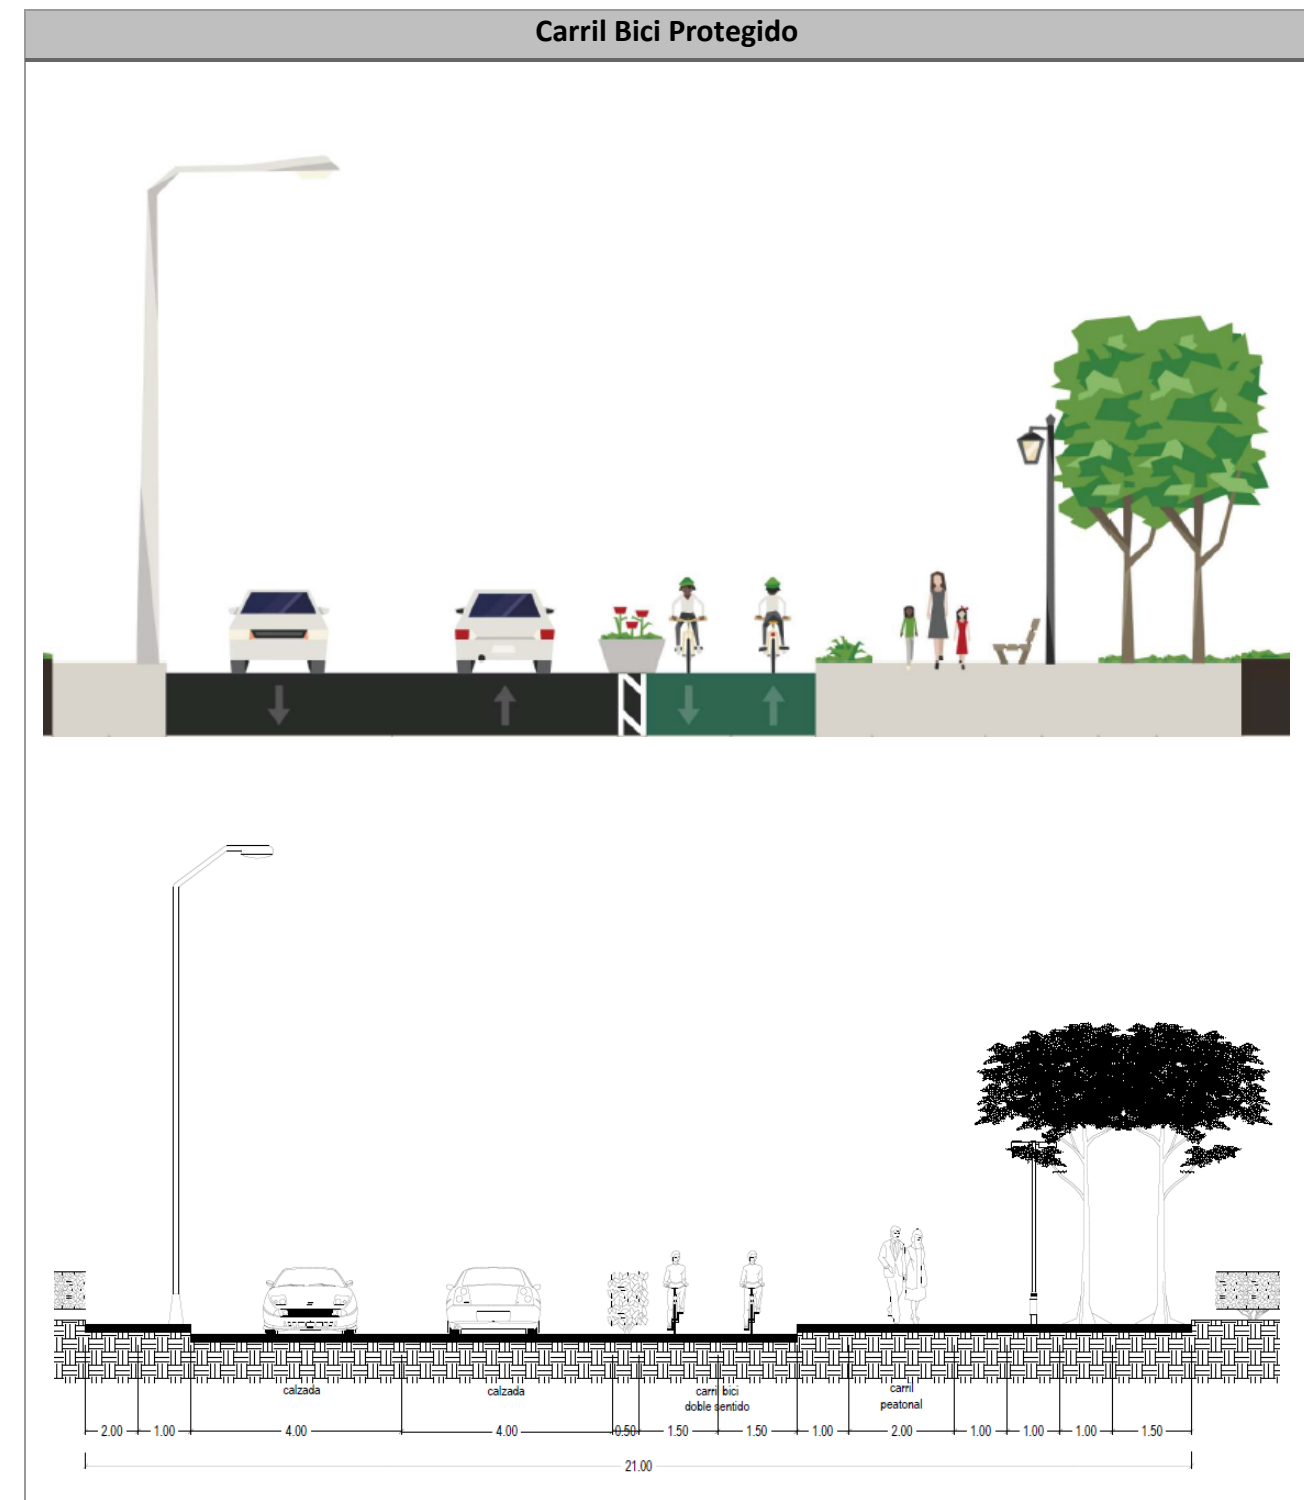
Sección transversal tipo para Carril Bici Protegido. Fuente: Elaboración propia.
